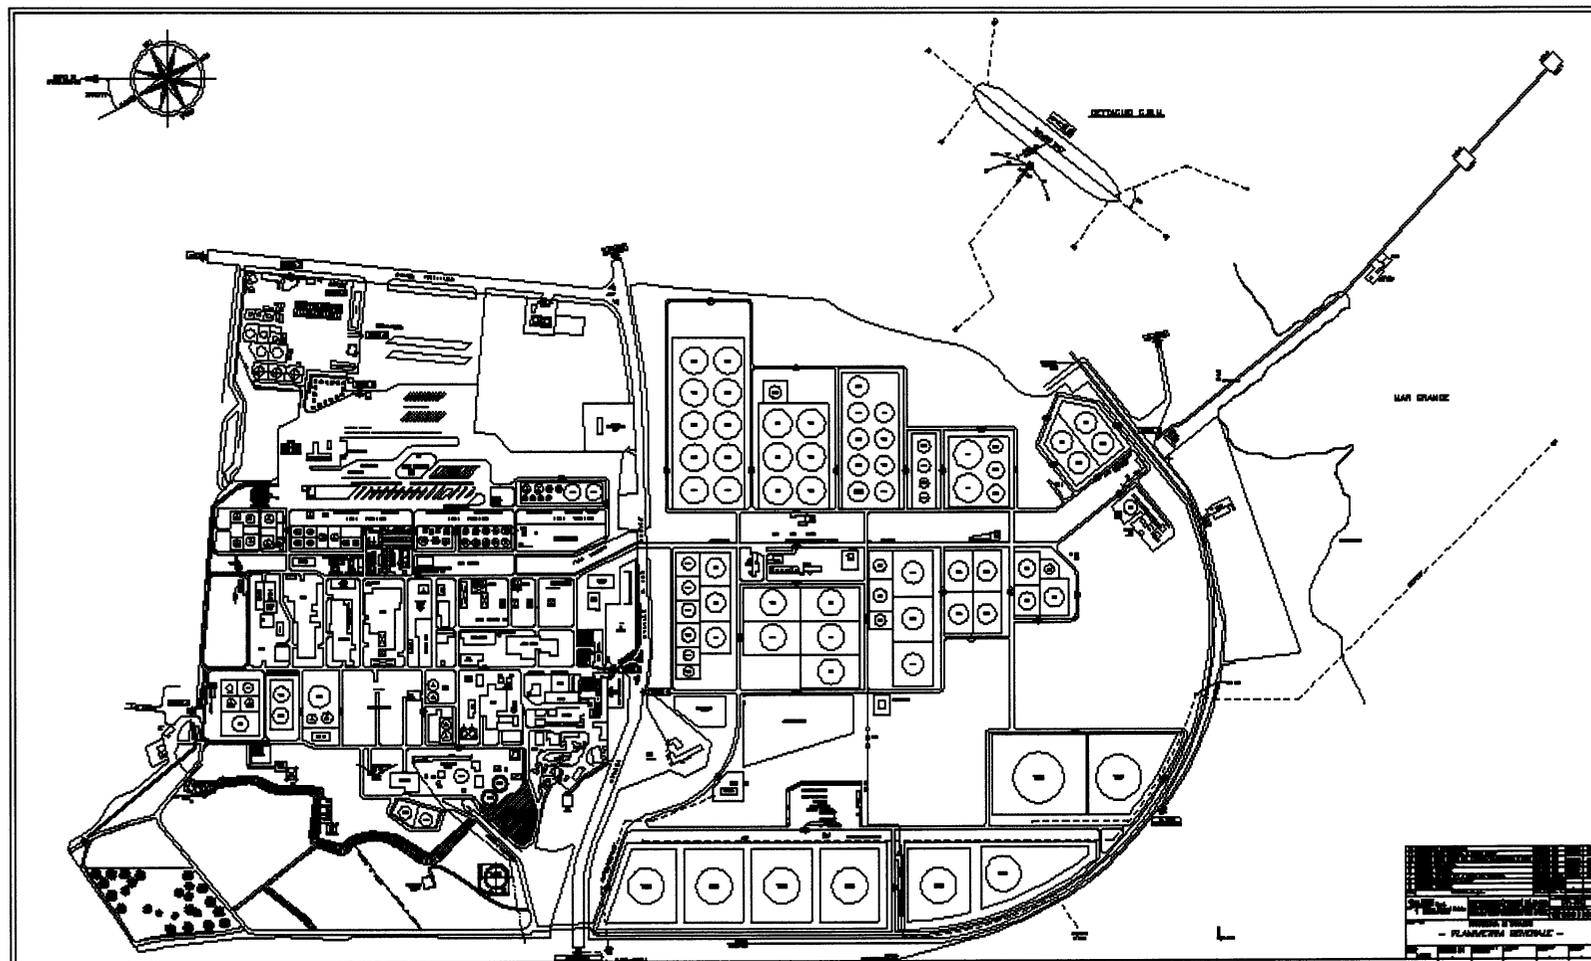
A: Planimetria generale Raffineria di Taranto
